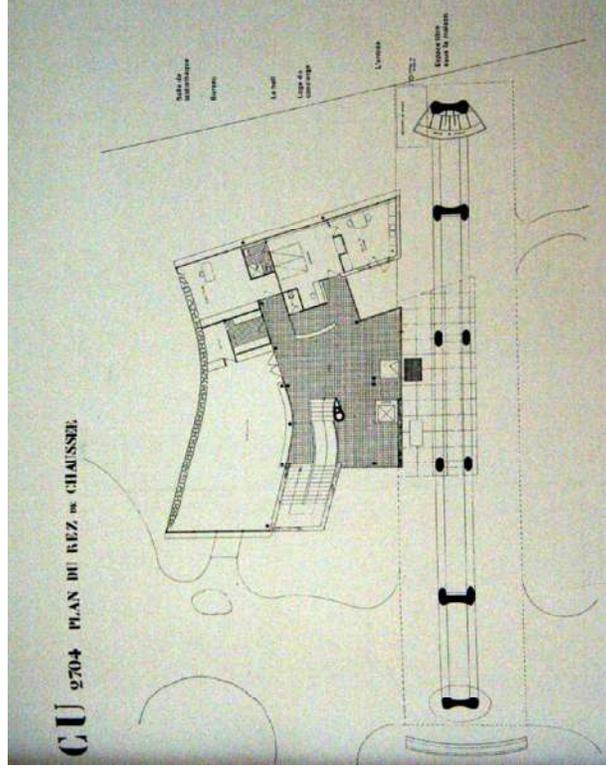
Planta Térrea do Pavilhão Suíço (1930-32).
